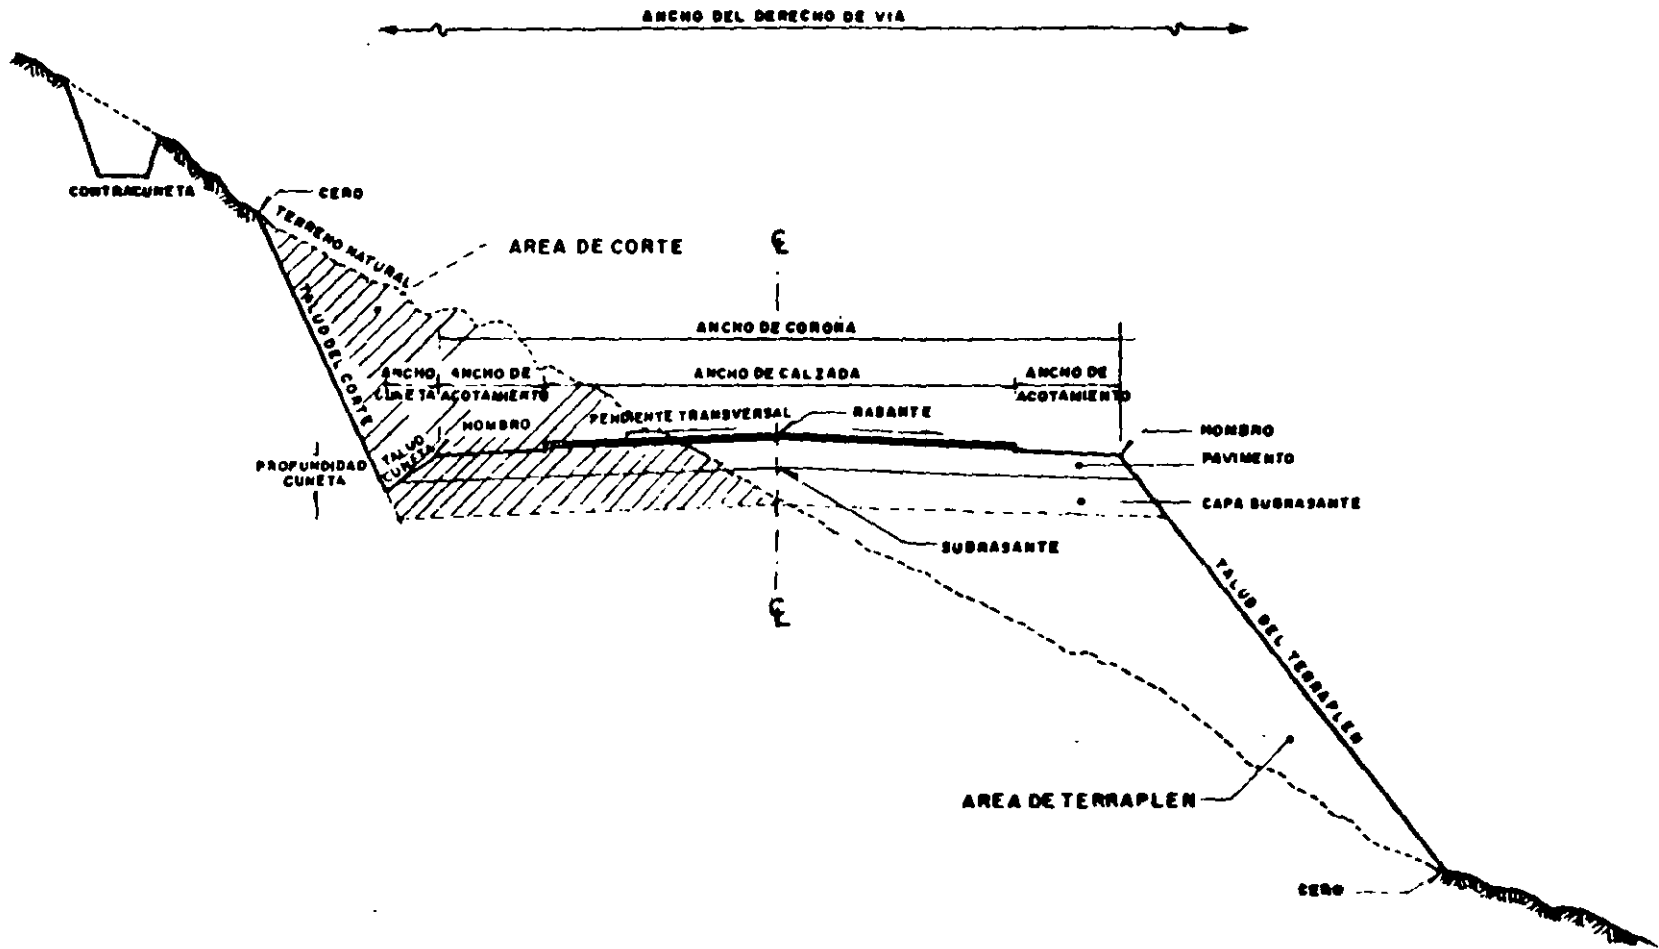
SECCION TRANSVERSAL TIPICA EN UNA TANGENTE DEL ALINEAMIENTO HORIZONTAL
